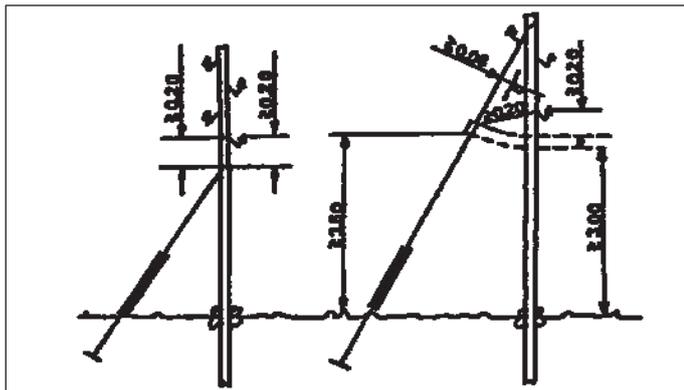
Установка оттяжек на воздушную линию электропередачи низкого напряжения с неизолированными проводами.
